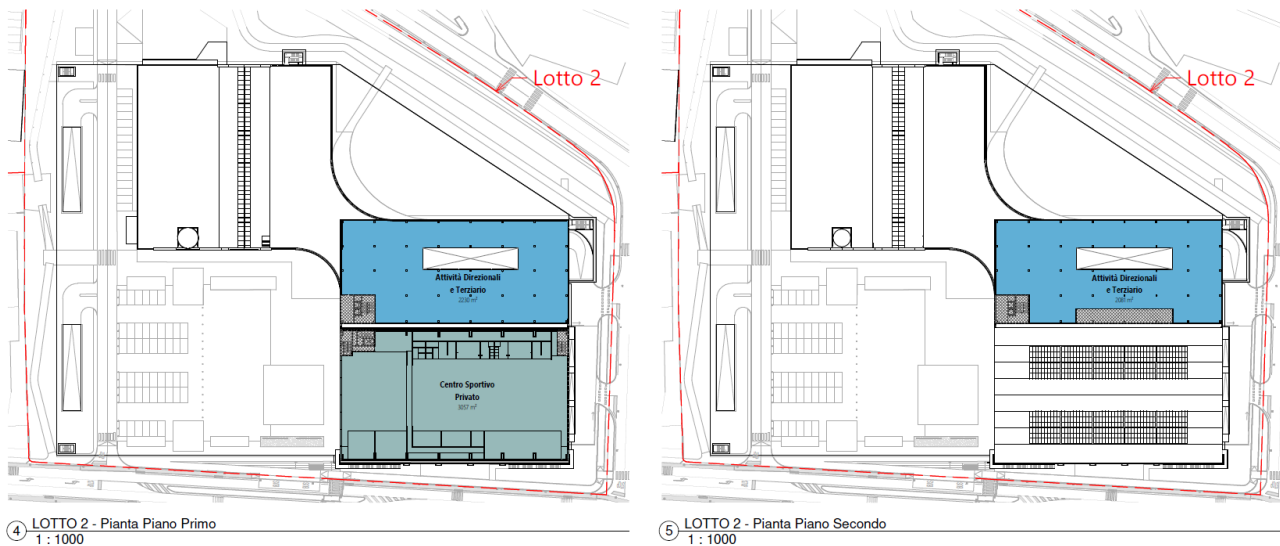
Stralcio piante del Complesso Multifunzionale - Piano primo e piano secondo.
